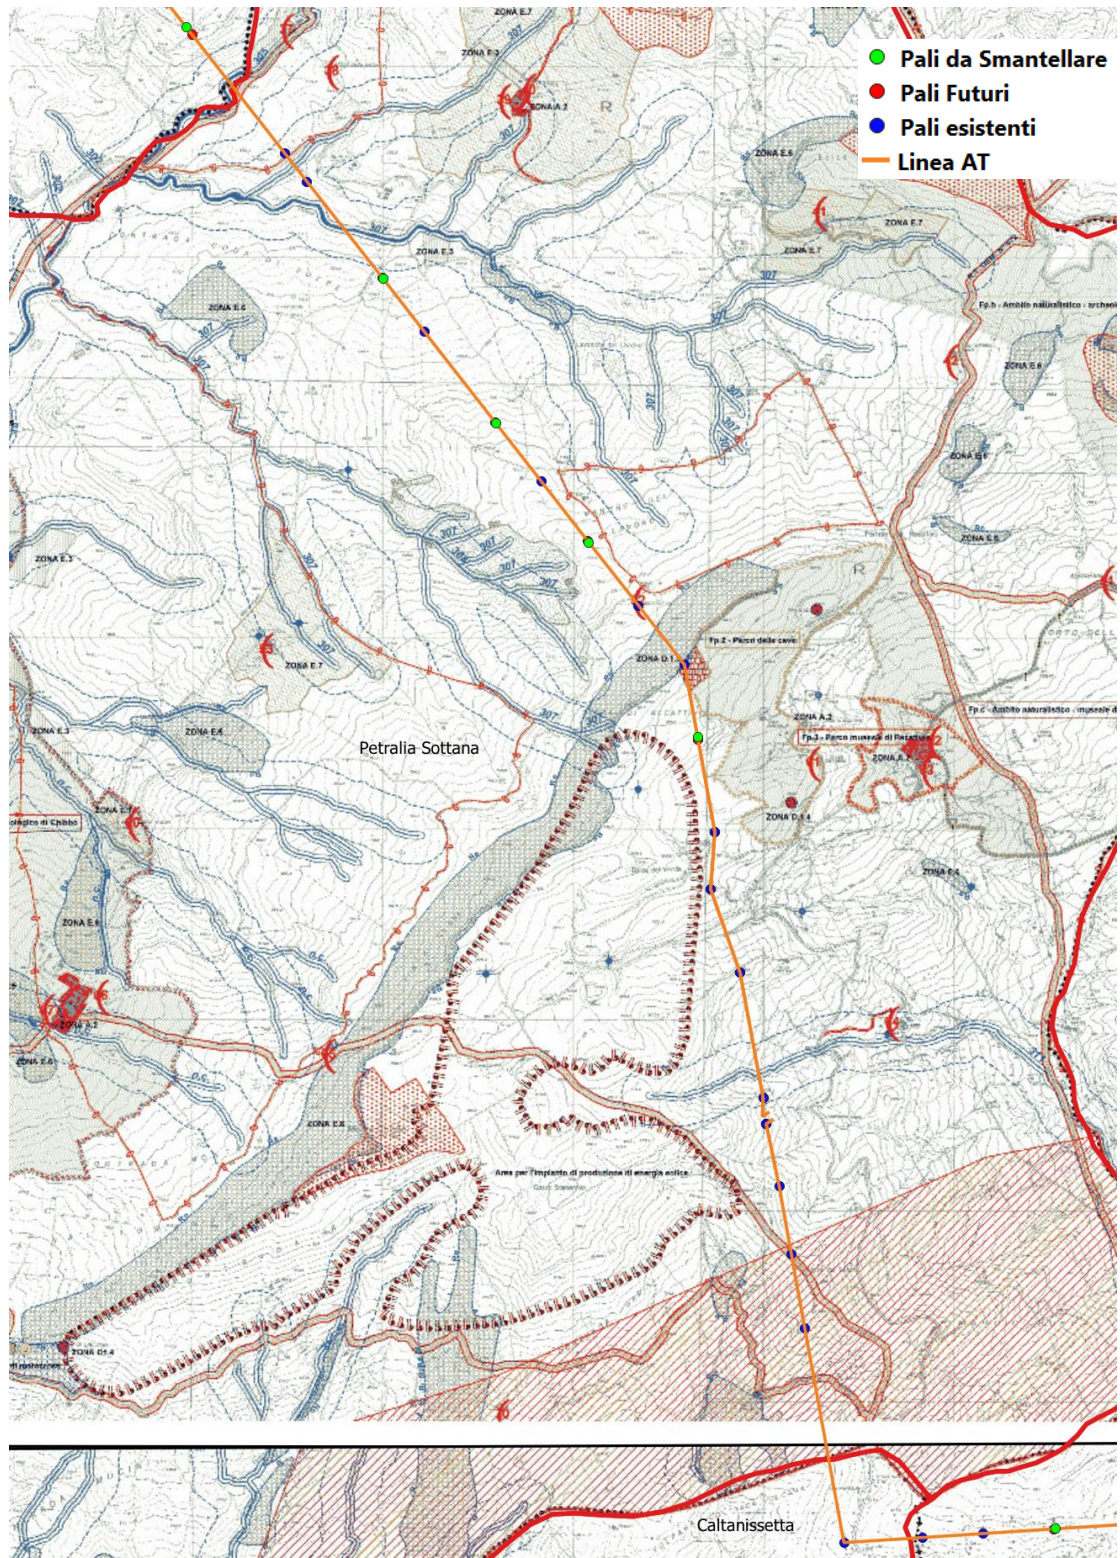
Estratto elaborato Tavola P.1.3 – Planimetria di progetto. Territorio extraurbano meridionale
